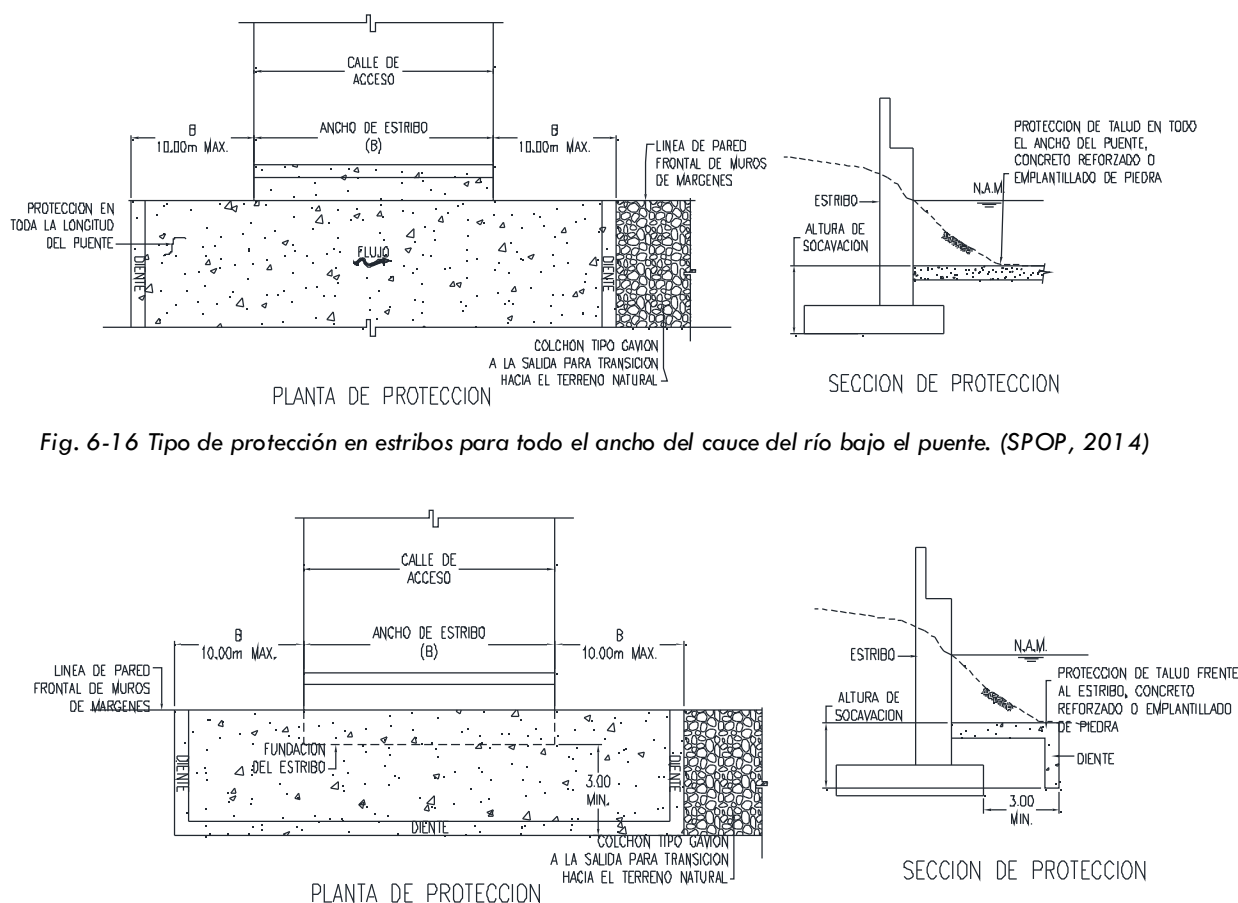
Tipo de protección en estribos para todo el ancho del cauce del río bajo el puente. (SPOP, 2014)
